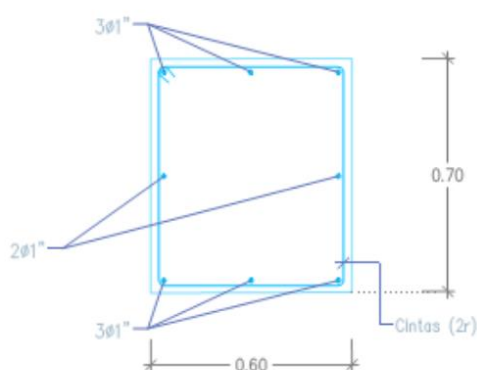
Corte representativo das armaduras detetadas no Pilar P1-I
